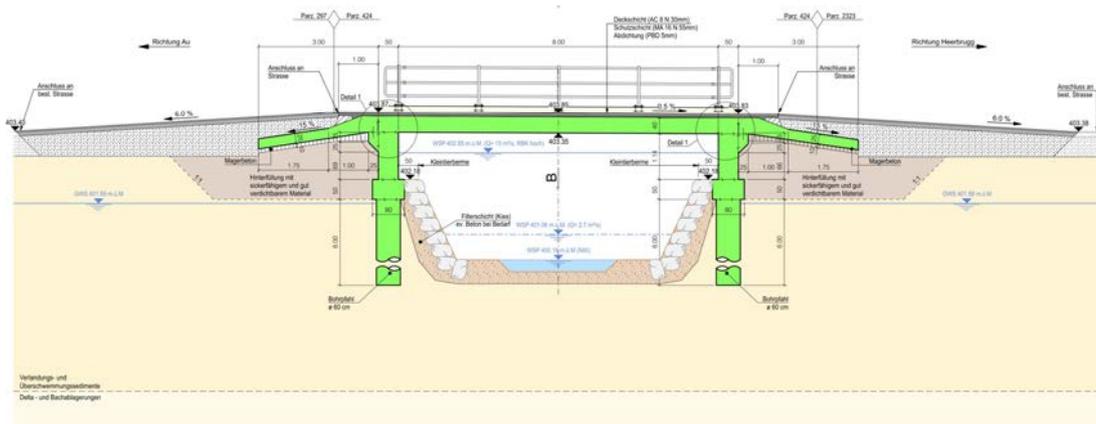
Vertikale Linienführung der Brücke Emserenstrasse, Ächeli
